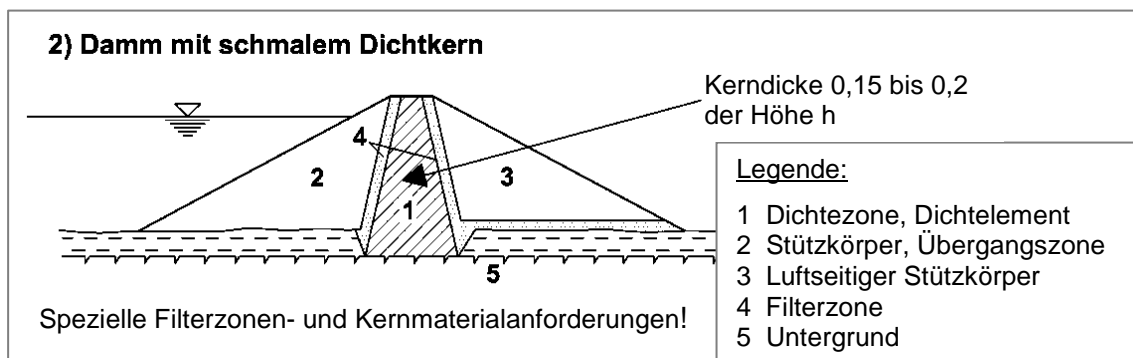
Dammbau mit schmalen Dichtkern [59: S. 24]
